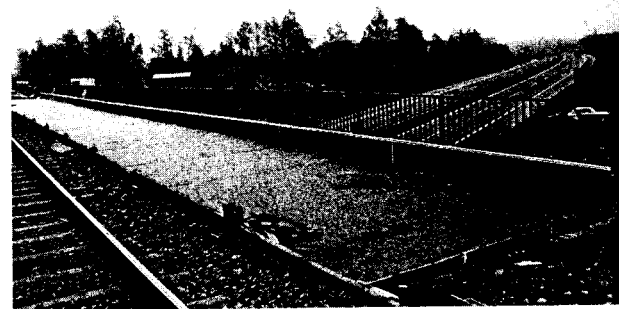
Gesamtansicht einer mit PUR-Matten belegten Eisenbahn-Stahlbrücke vor dem Einbau des Schotterbetts
